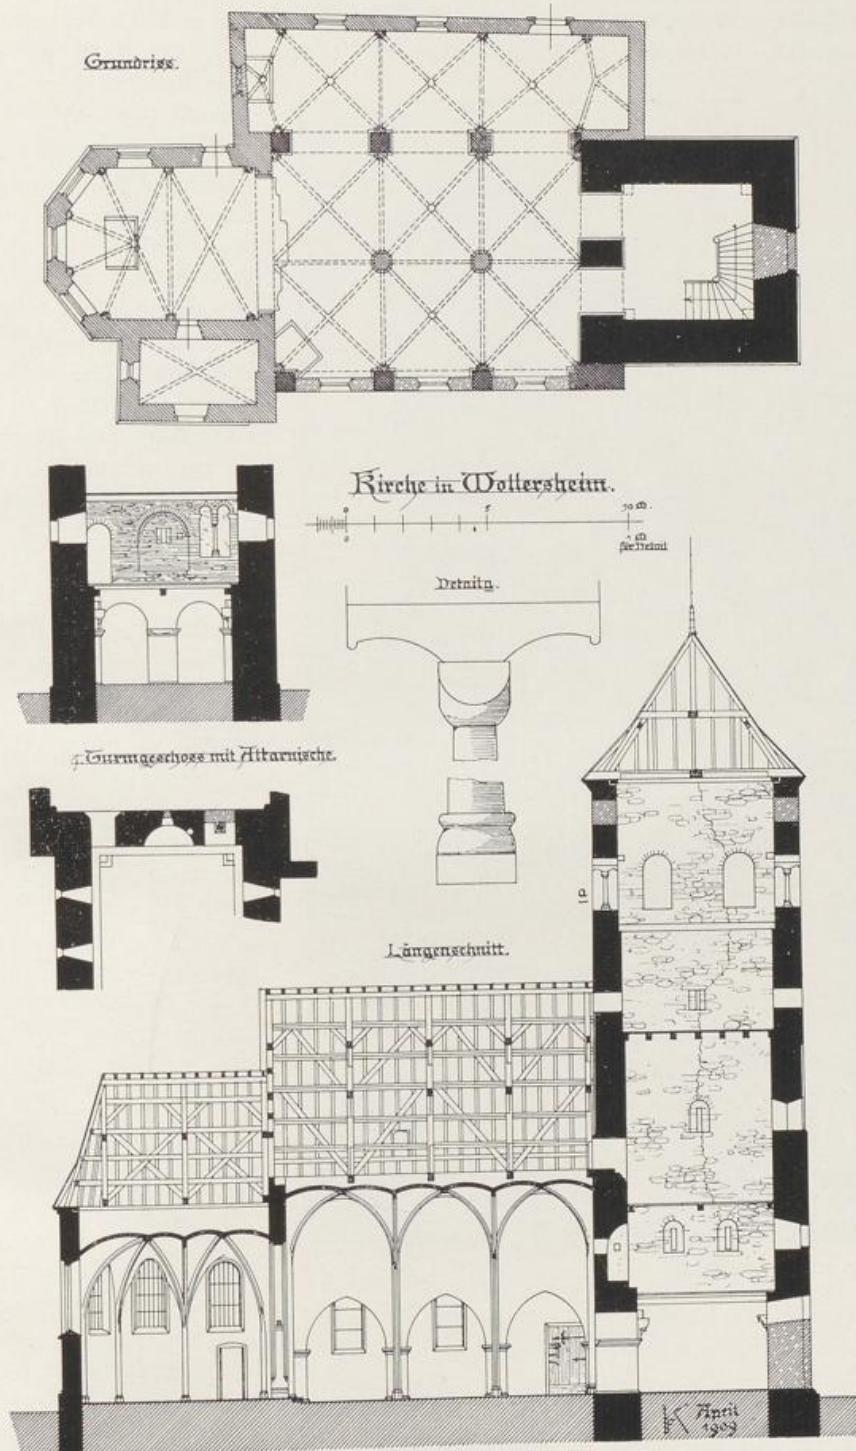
Wollersheim, alte kathol. Pfarrkirche. Grundriss, Schnitte und Detail.
